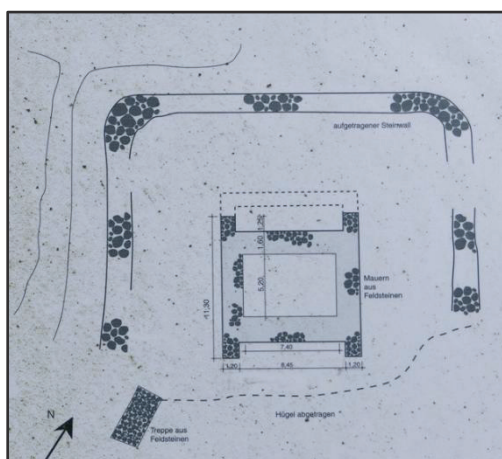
Lageplan der Turmhügelburg Maledai, Informationstafel am Untersuchungsstandort in Schlicht.
